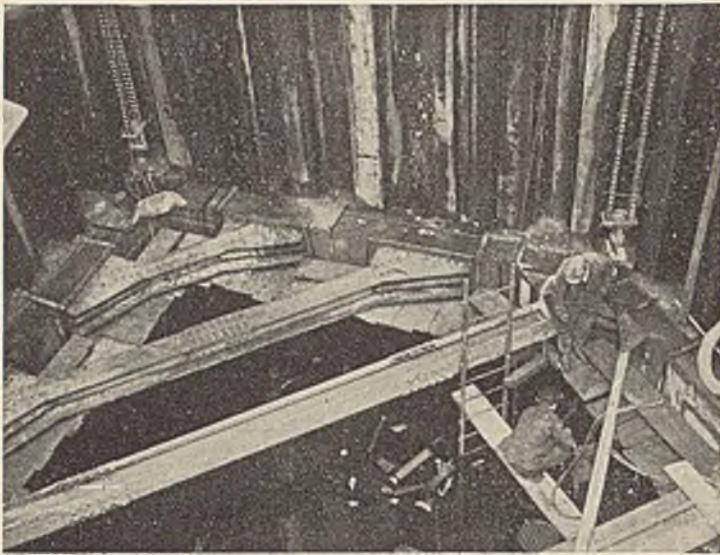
Ecke der Baugrubenaussteifung bei Pfeiler 9.
